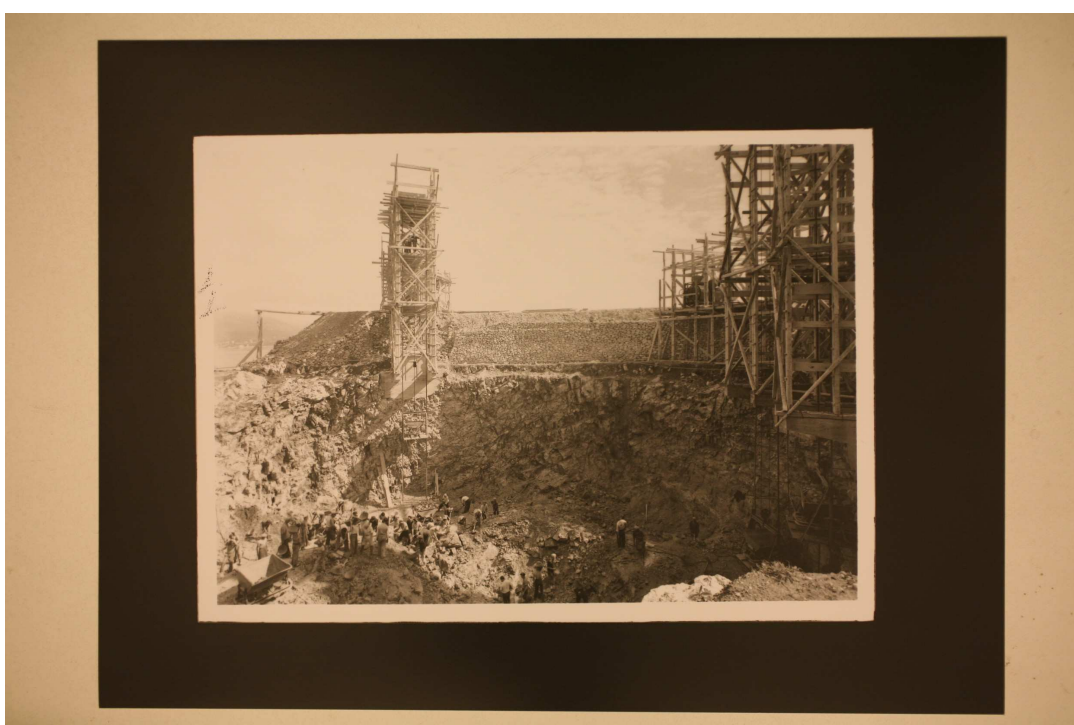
, Archivio Vasari, (Cantiere aviorimessa I tipo), 1935, CSAC, sezione fotografia.
